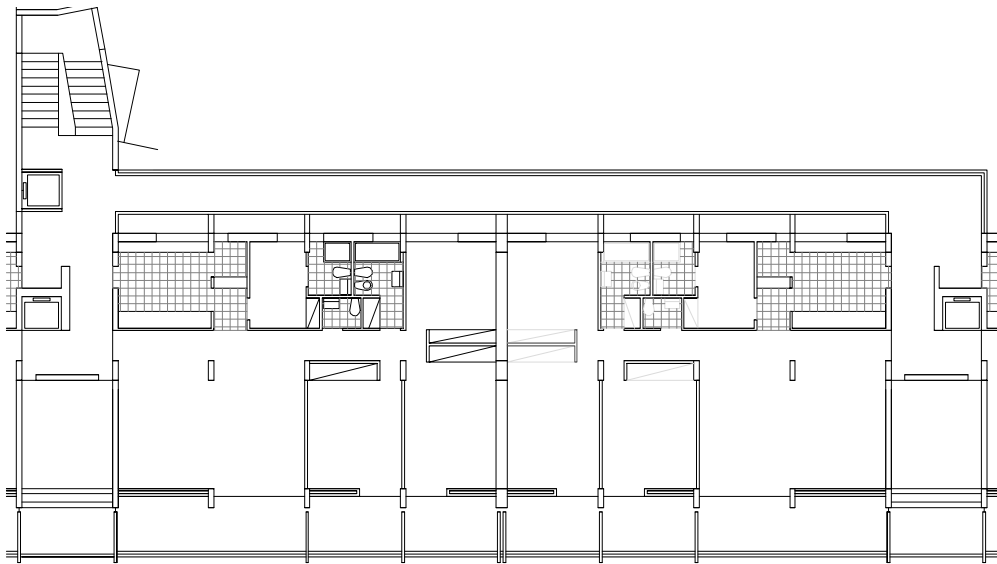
Planta Tipologia Blocos Olivais Norte 1:200
